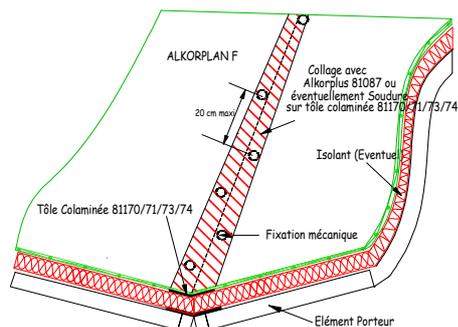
Soudure en noue sur tôle colaminée
